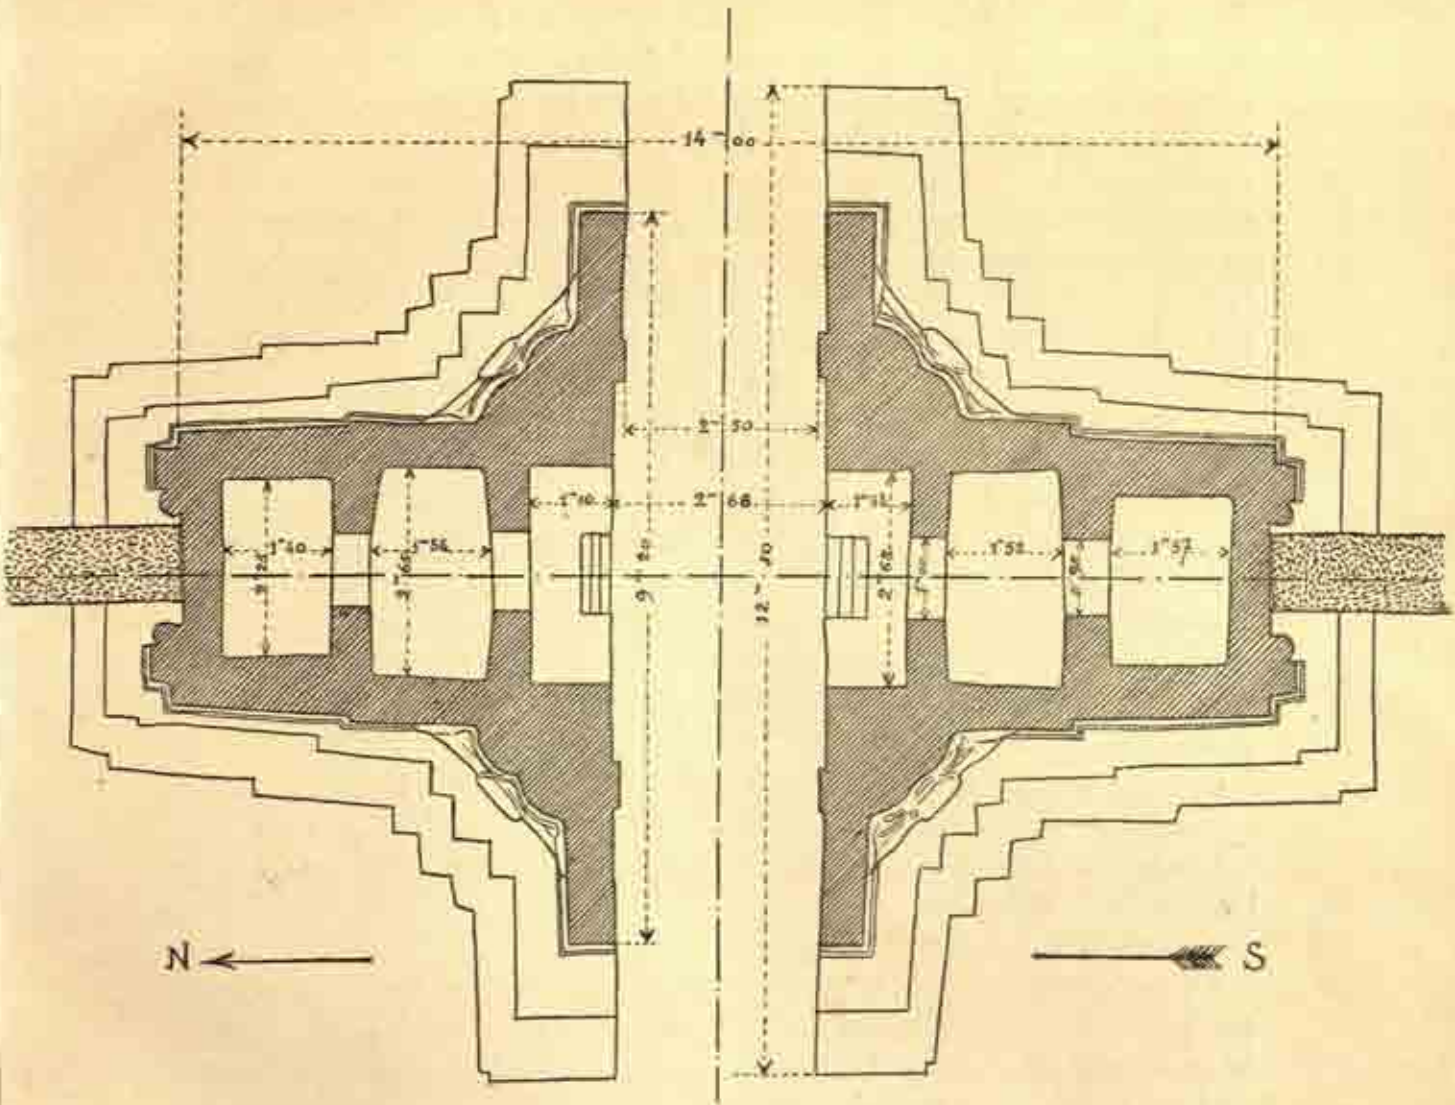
Plan de la porte Ouest de Ta Prohm.
